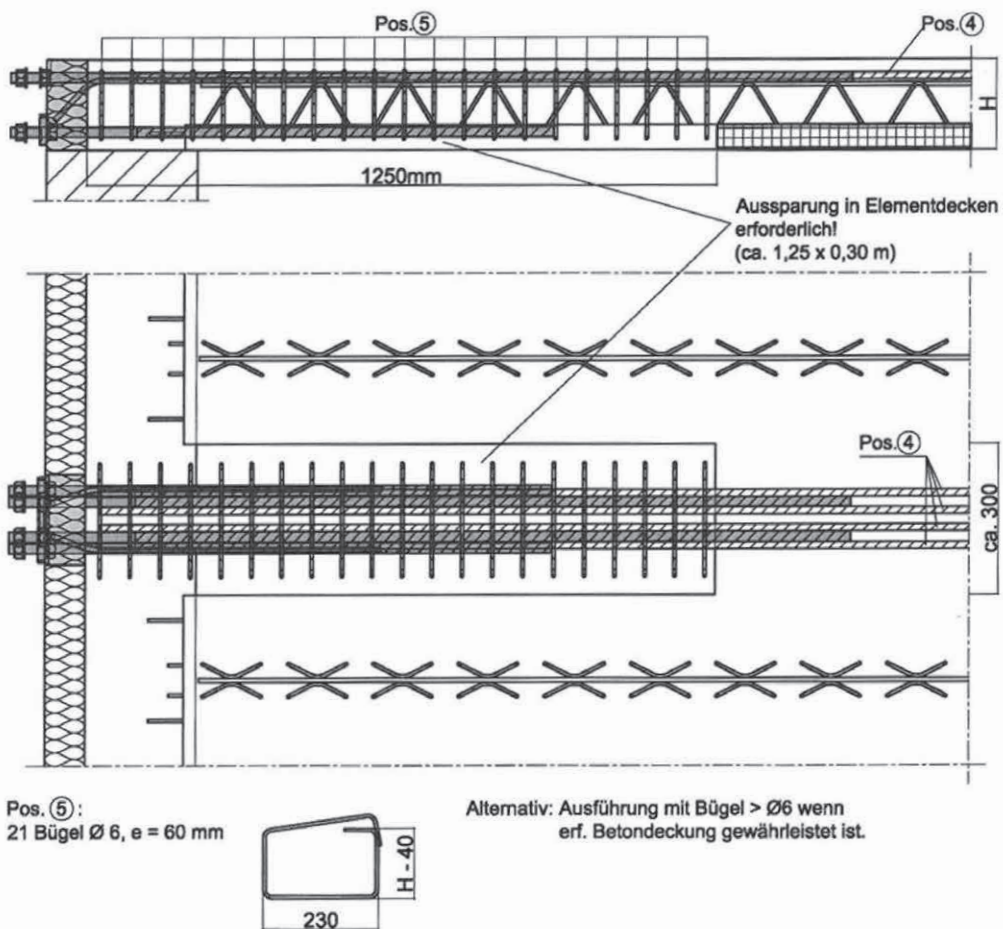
Bauseitige Anschlussbewehrung für Schöck Isokorb® Typ KS20 V10 und KS20 V12
